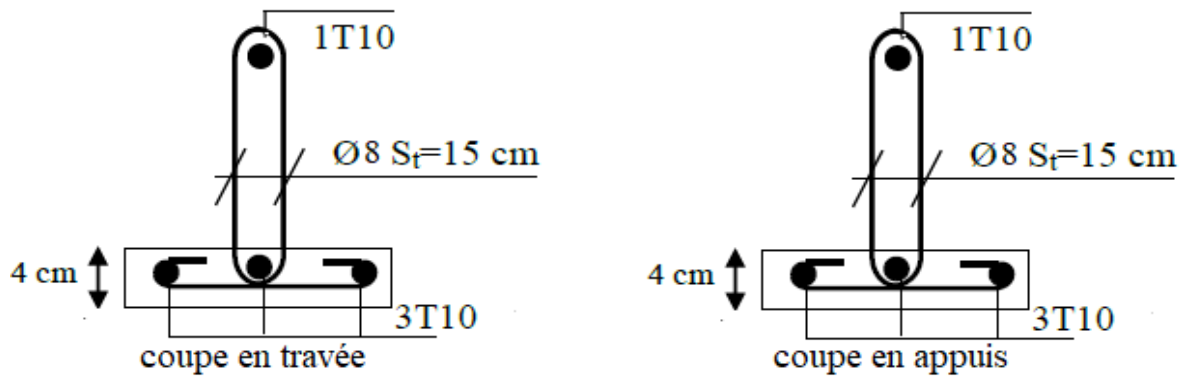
Schéma de ferrailage des poutrelles de rives Plancher terrasse
